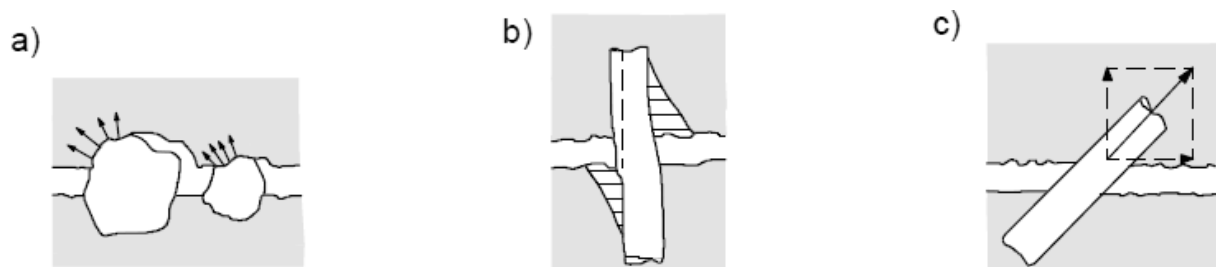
Mechanismen der Schubkraftübertragung im Riss a) Rissverzahnung, b) Verdübelung, c) Zugkraftaufnahme durch eine den Riss kreuzende Bewehrung aus [59]
